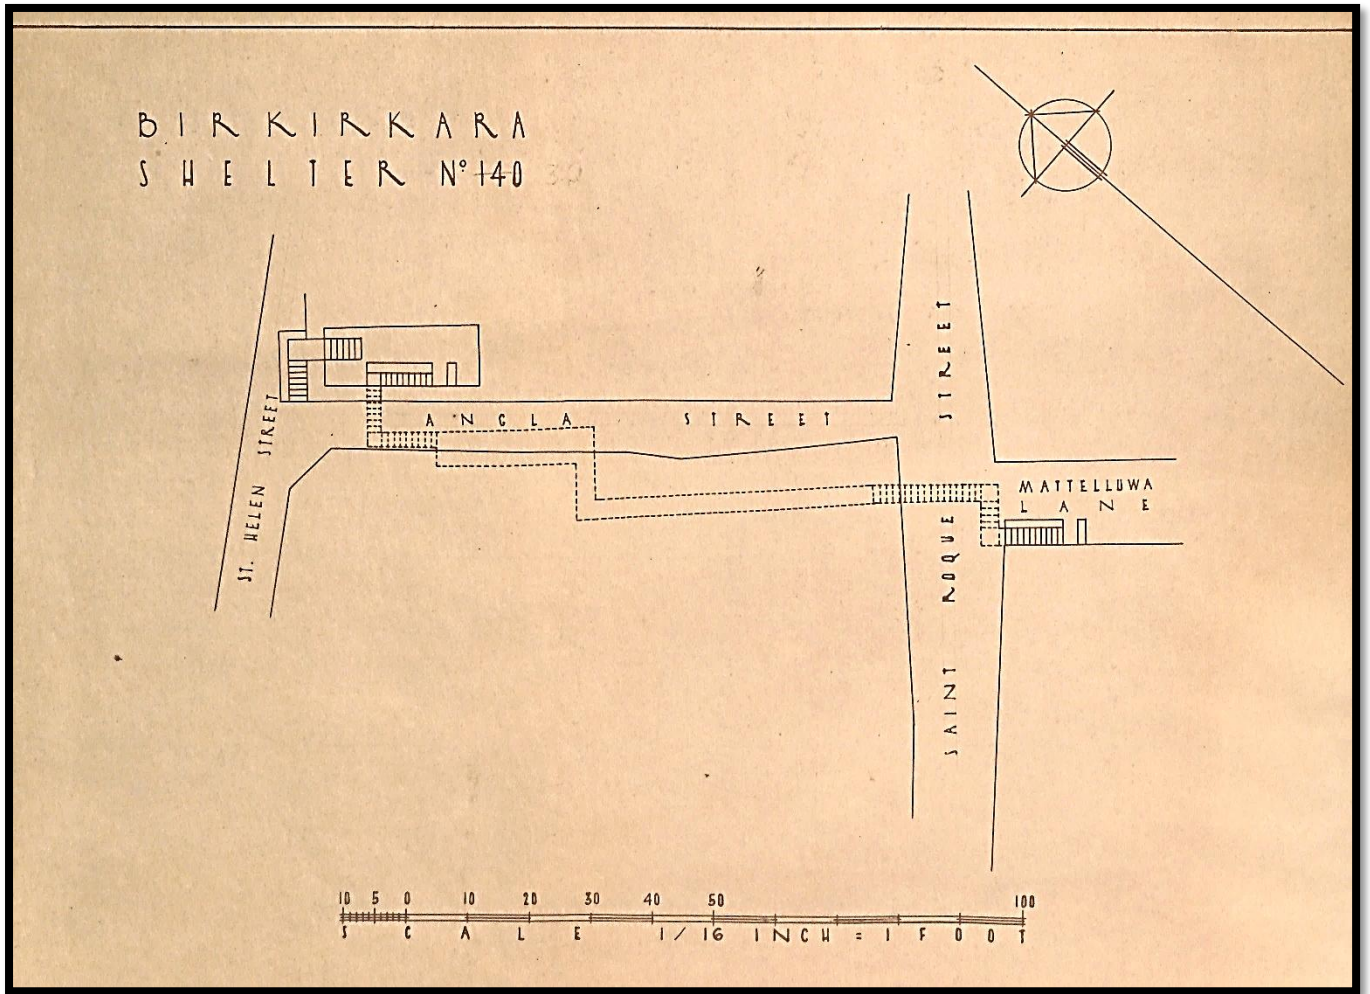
Planta do Abrigo nº140 (30) "St. Helen Street – Ancla Street – Saint Roque Street – Mattelluwa Lane."
